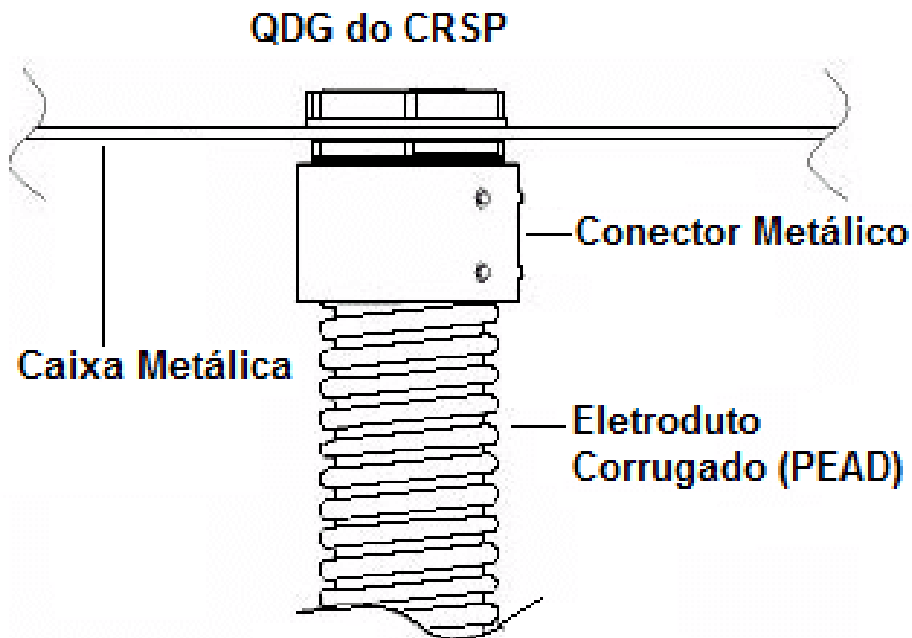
Fixação do eletroduto corrugado em caixa metálica
